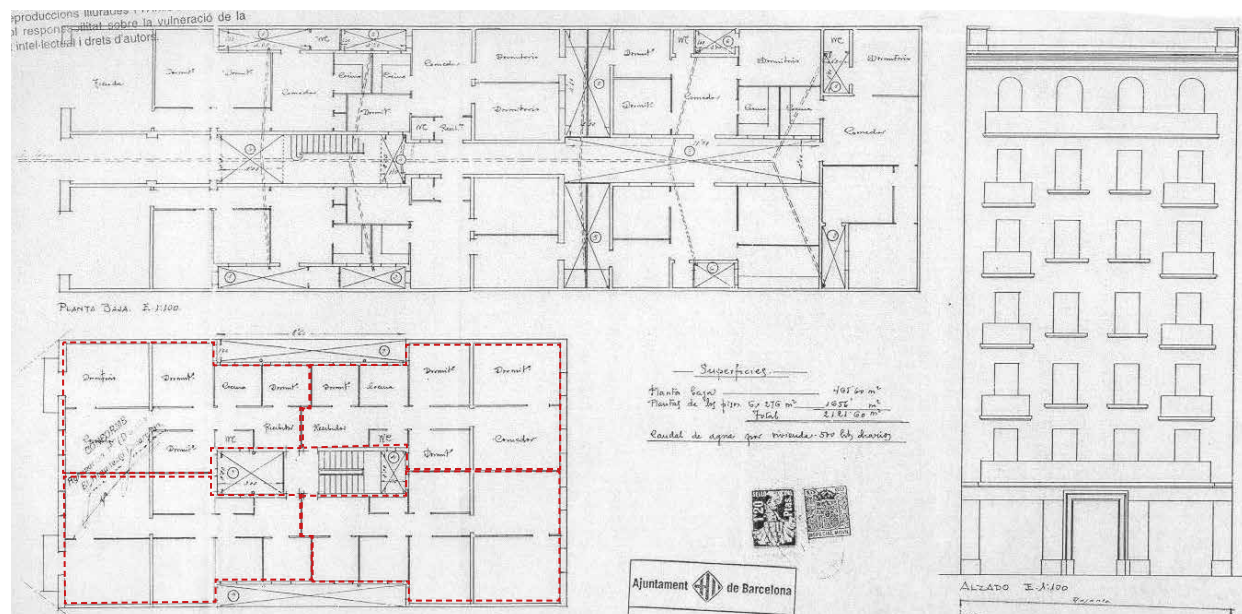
Fachada, planta baja con el pasillo y planta de los pisos (4 viviendas por rellano) de un edificio de la Izquierda del Ensanche de 1930.
